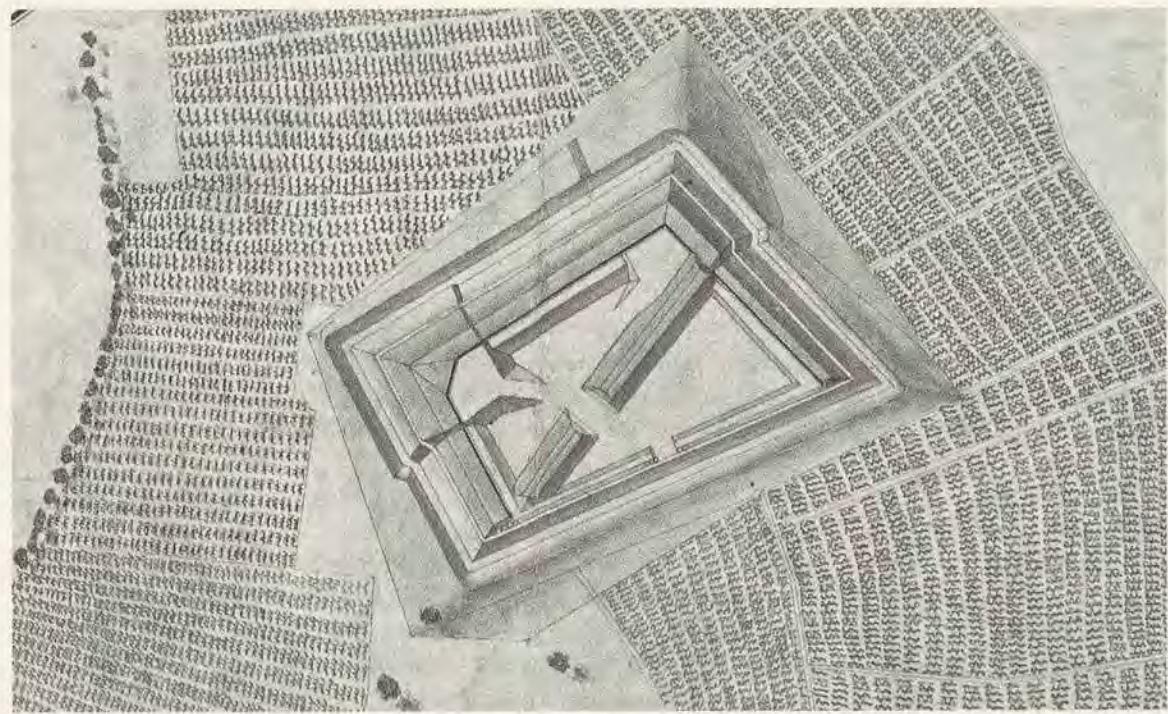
La redoute de la Crête (W 10). Détail du plan Dürr, 1851.
